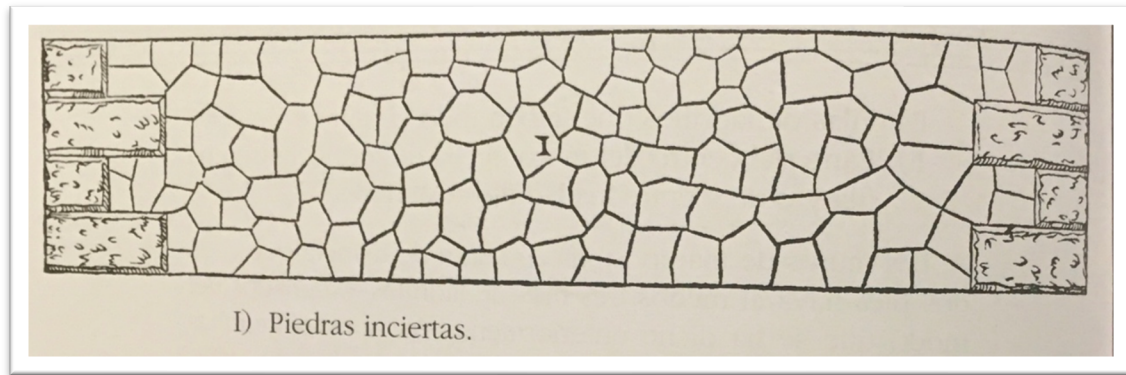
Sistema constructivo para muros de mampostería con piedras inciertas.
